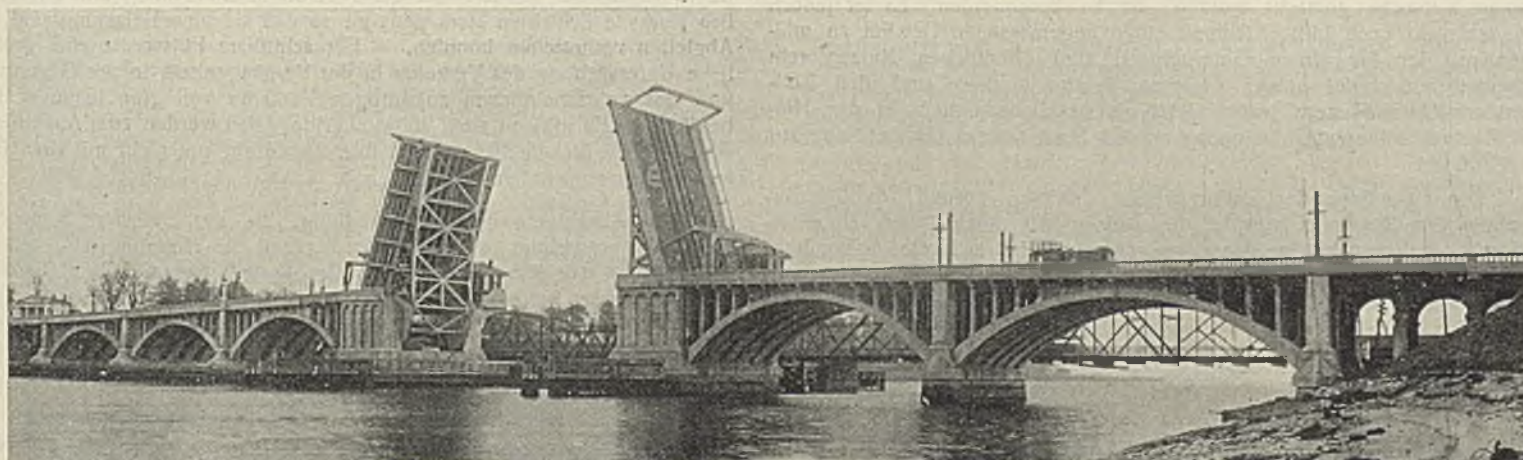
Die „Washington Brücke“ über den Housatonic River mit Klappbrücke. Die Fahrbahnbreite beträgt 13,1 m mit zwei Straßenbahngleisen. Die Fußgängerstege sind 2,4 m breit. Die Entfernung zwischen den Drehzapfen beträgt 53,4 m. Die Lichtweite = 38,0 m.
